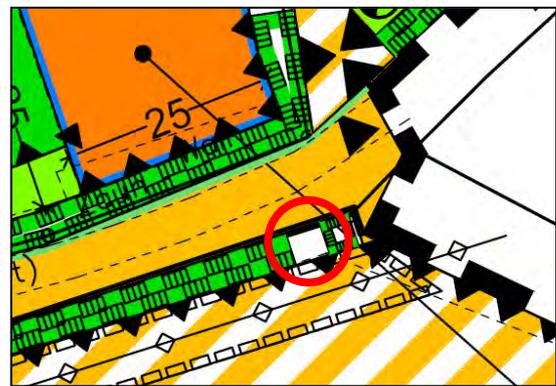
Ausschnitt Wallhecke aus B-Plan Nr. 83 B (unmaßstäblich)
